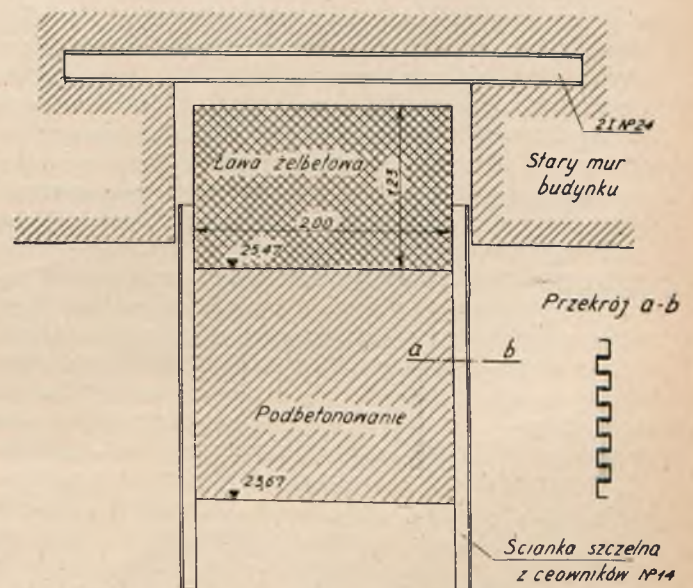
Przekrój konstrukcji nad otworem środkowym.
